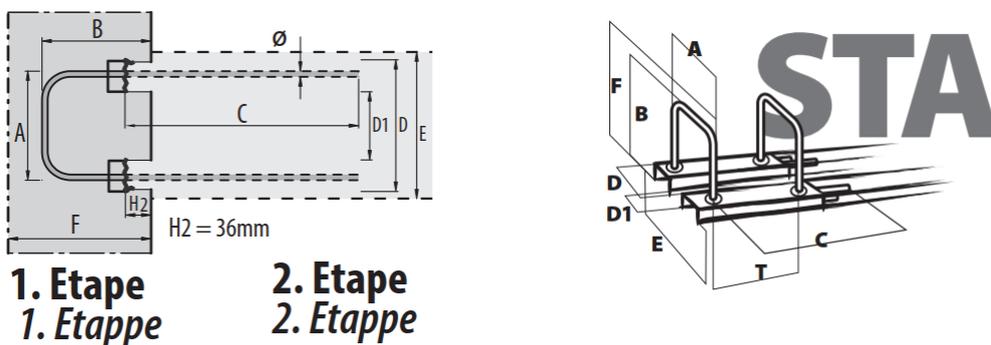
Rückbiegeanschluss HBT-STA mit maßgebenden Abmessungen
